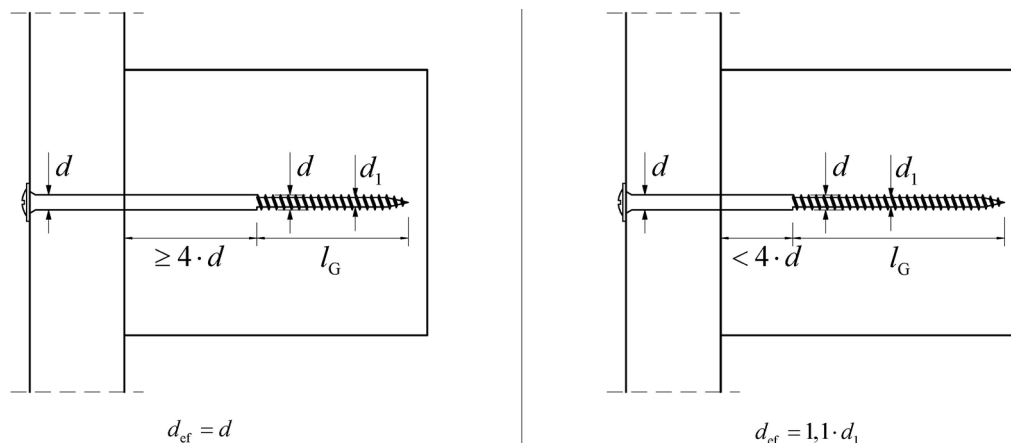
Wirksamer Durchmesser von Holzschrauben
